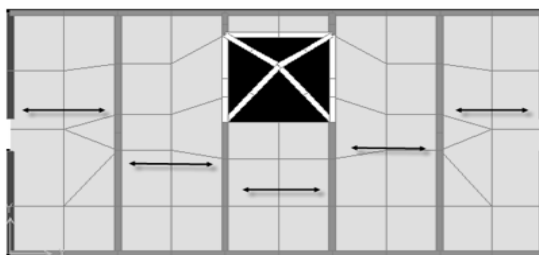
Distribuição das cargas da laje e consequente modelo das vigas
